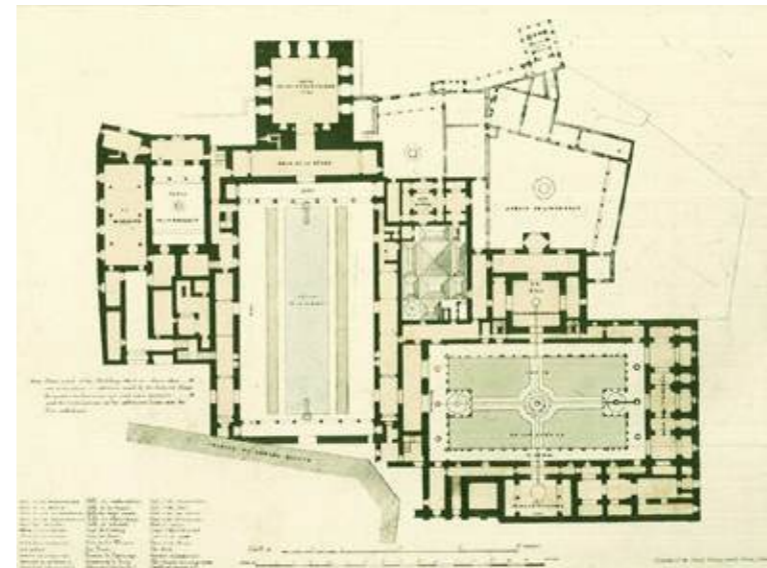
Planta general de los palacios nazaríes de la Alhambra (Archivo Junta de Andalucía)
